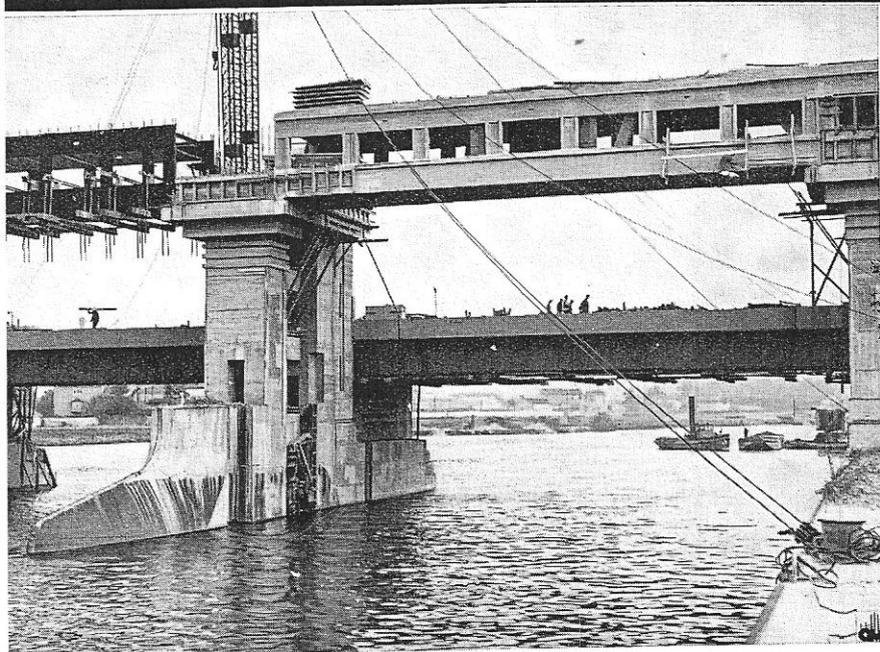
Vue amont du barrage. On voit le pont-route situé en aval et la construction de la passerelle de service en poutres Viendeel en acier enrobé.
